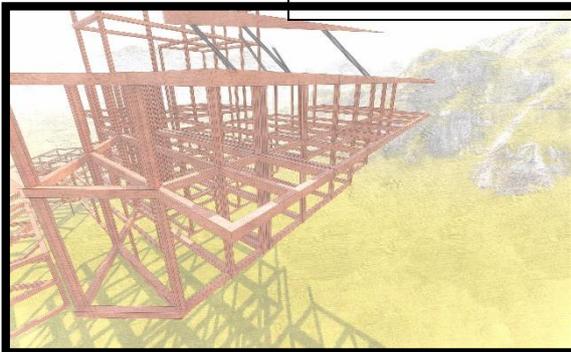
POTEAU EN BOIS EN PLAN , SOURCE , AUTEUR
